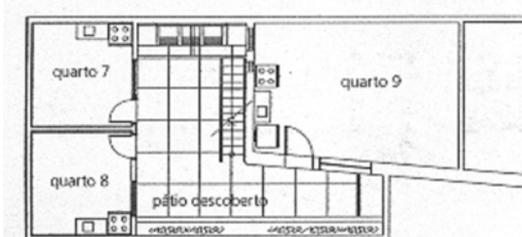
Planta do subsolo – sem escala. PREFEITURA, 2003.
